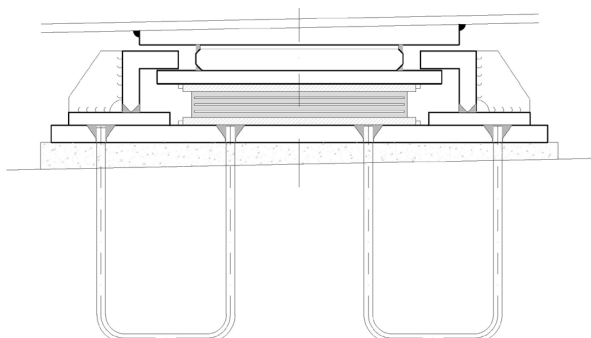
Abrazaderas en apoyos de los estribos de la E-10, E-11 y E-12.
